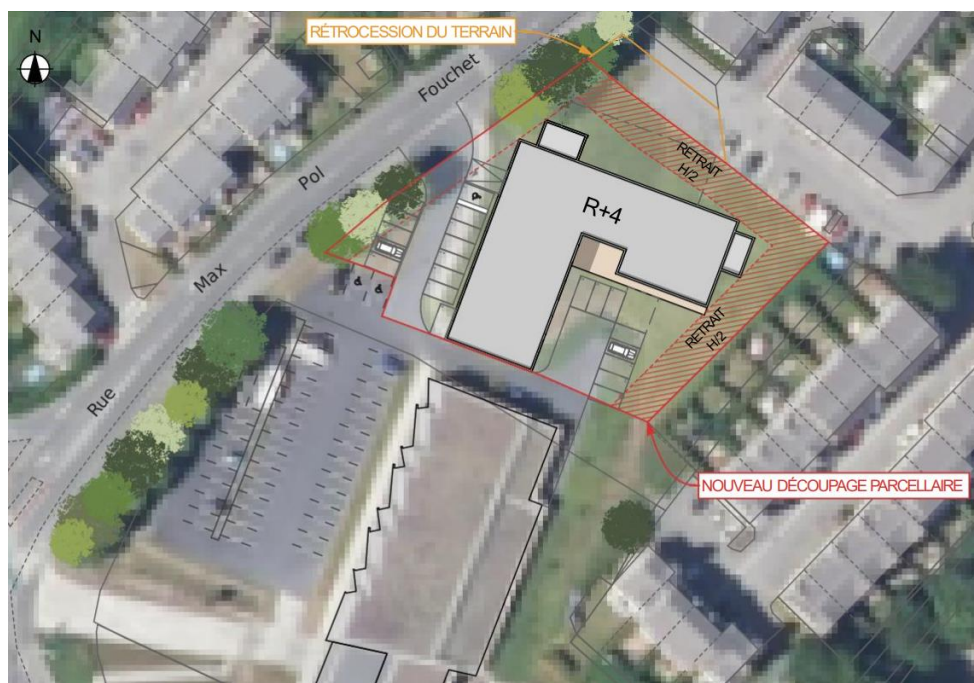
Plans de masse du projet - Source : EXO ARCHITECTES
